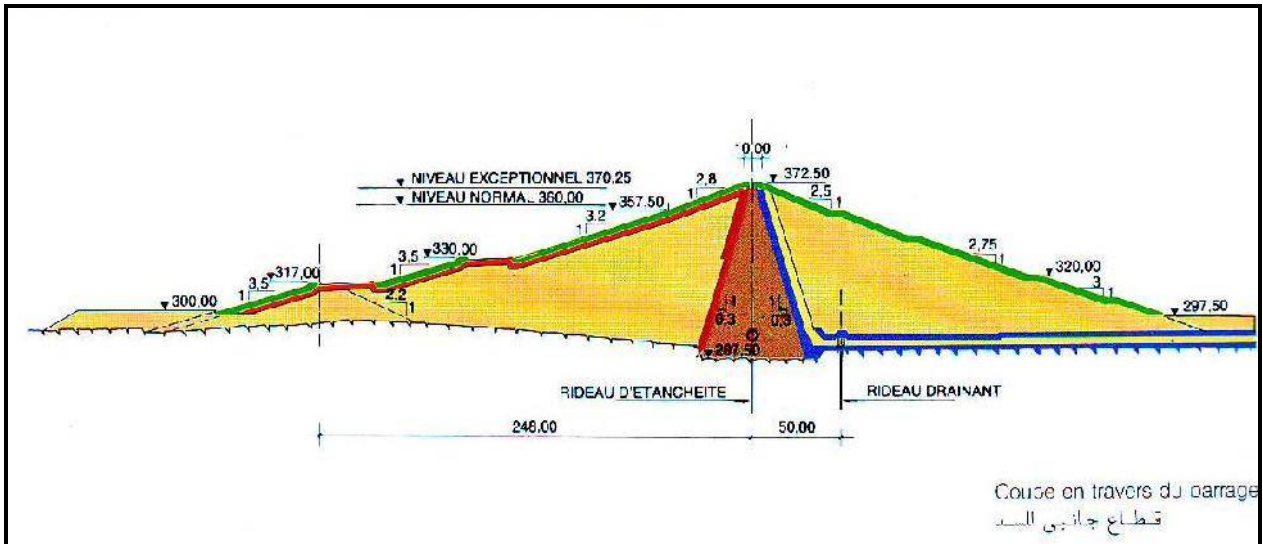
Coupe en travers du barrage de Hammam Debagh (d'après A.N.B.T.)
